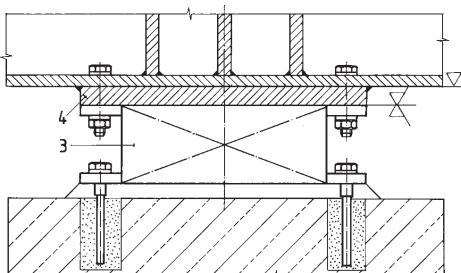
Stahlüberbau; Lagerfugen wie Bild 4.8
